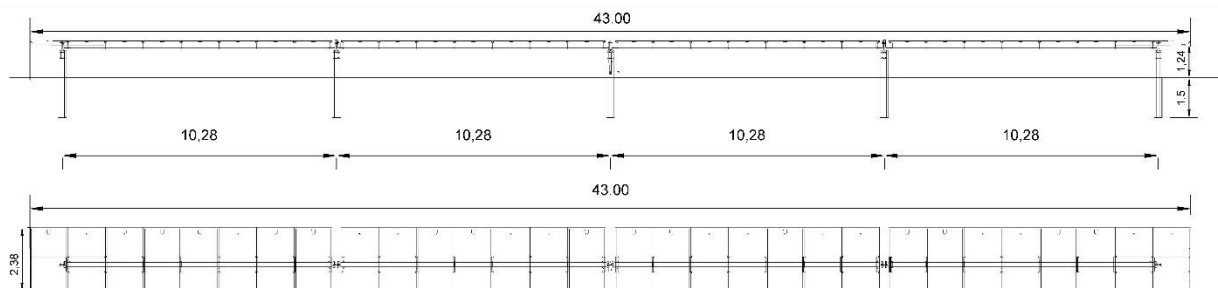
Prospetto frontale e vista in pianta delle strutture (30 moduli) ad inclinazione 0°
